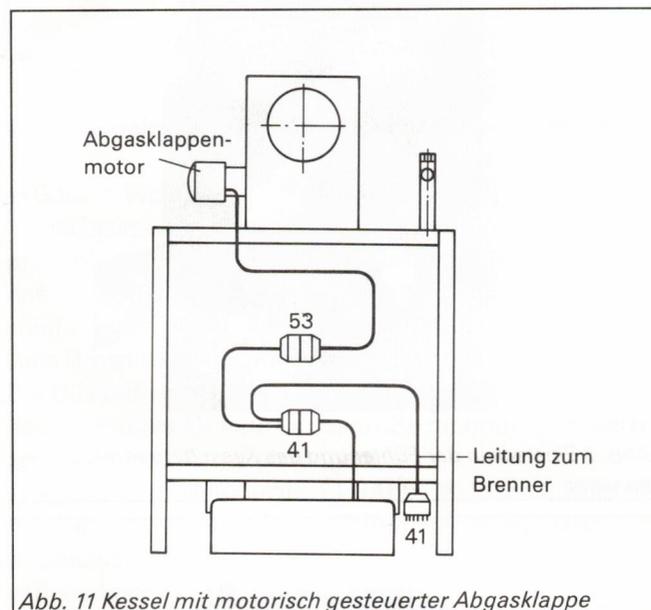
Kessel mit motorisch gesteuerter Abgasklappe
